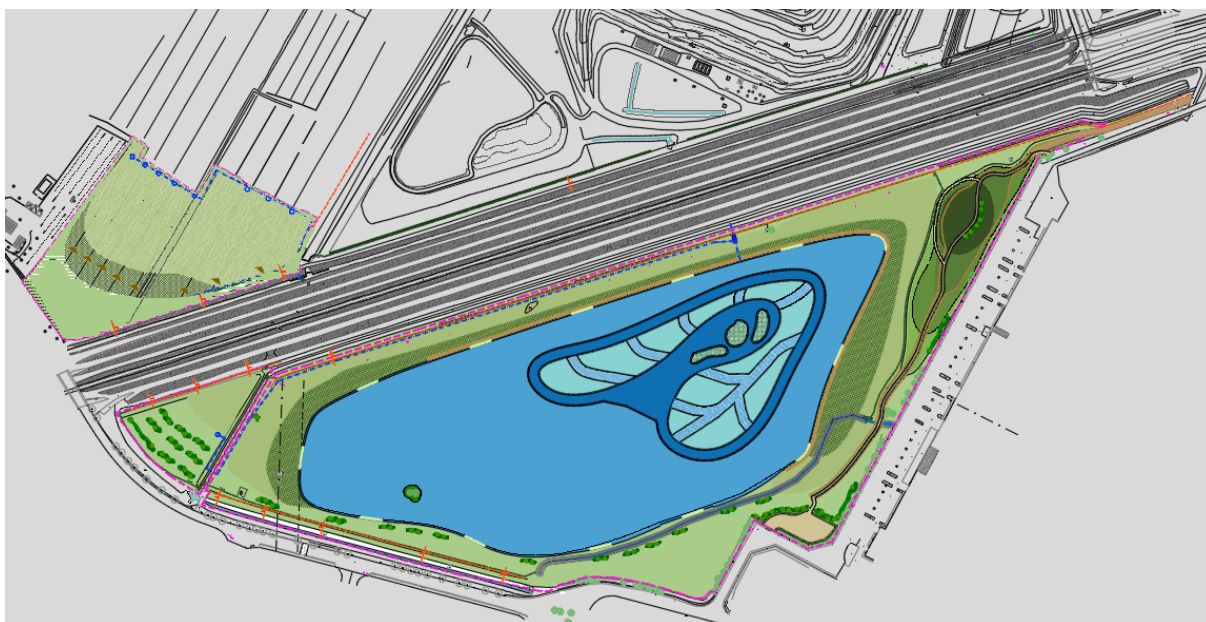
Schema di progetto dell'area di compensazione Santa Croce
